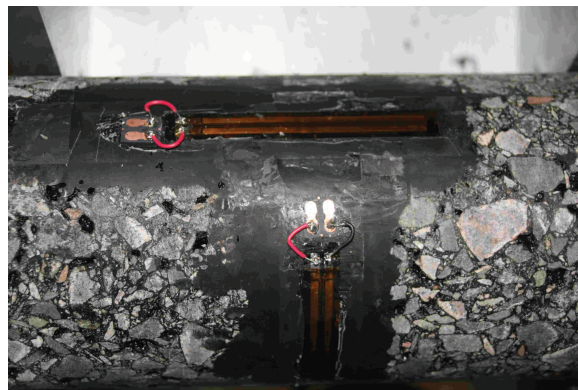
Soudure de deux fils entre la jauge et la cosse relais
